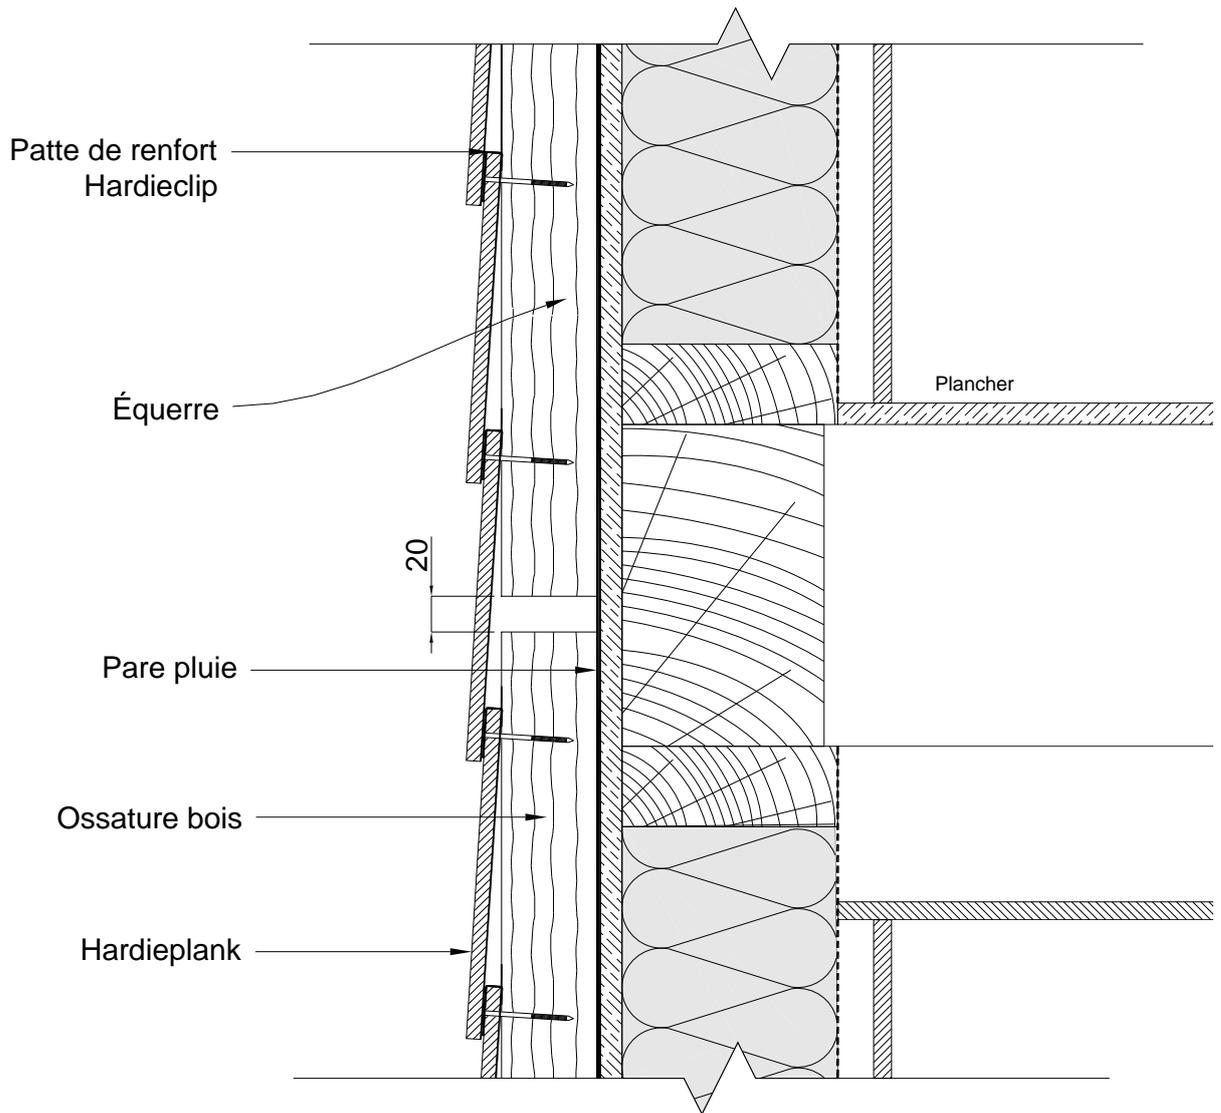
Fractionnement au droit de chaque plancher sur COB
